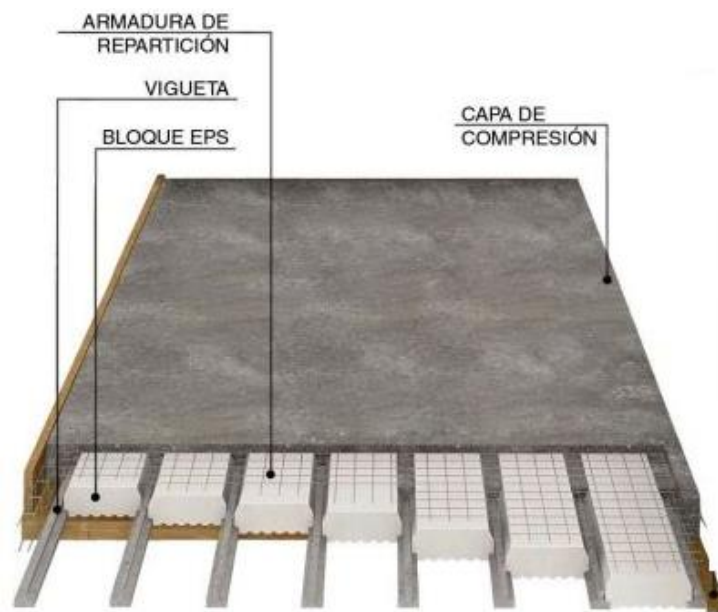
Sistema constructivo de la losa (Fuente: Tecnopor).
